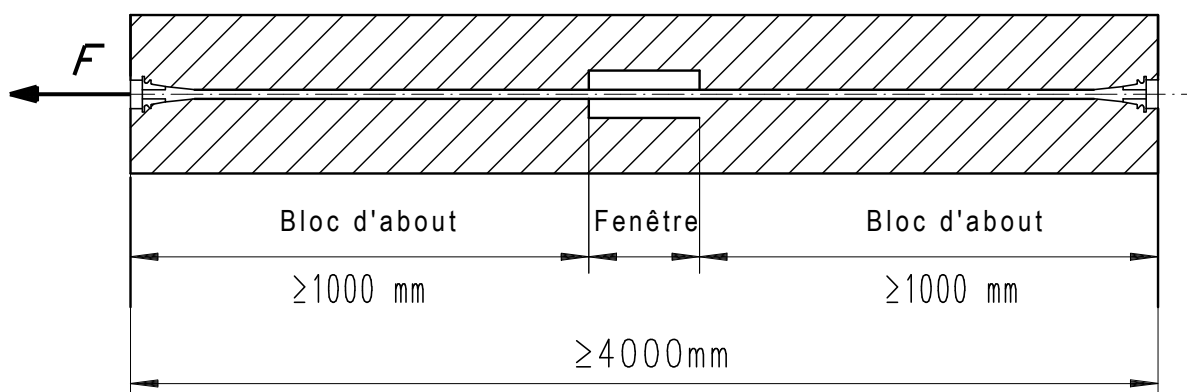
Installation pour l'essai de remplacement d'un câble extérieur
